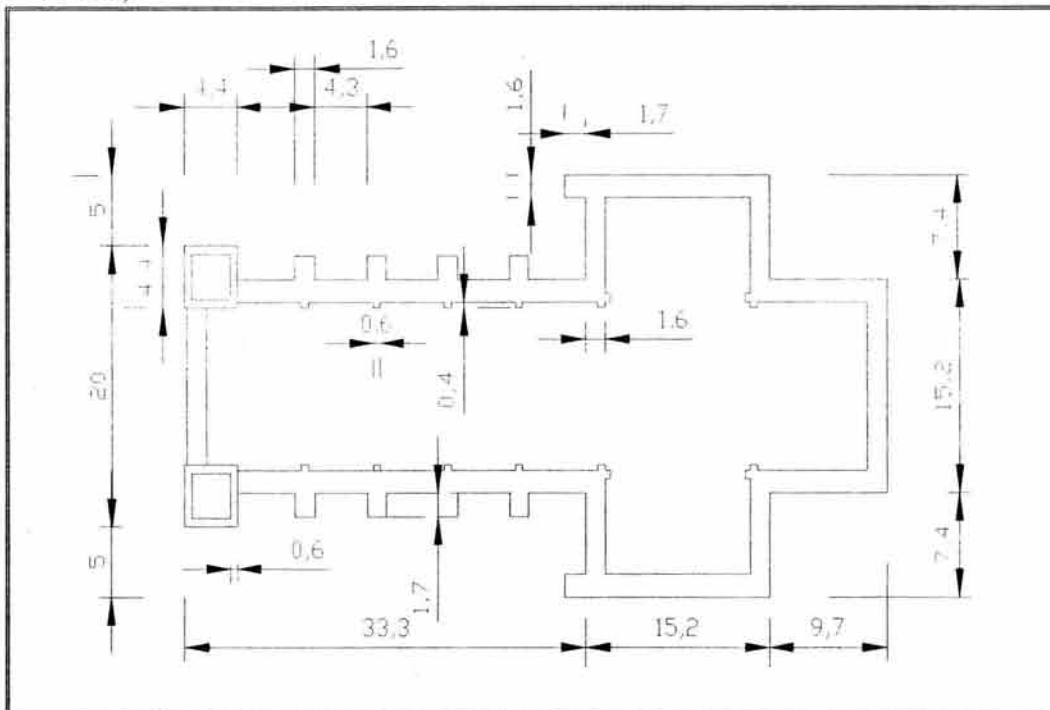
Planta de iglesia en cruz latina (m)
